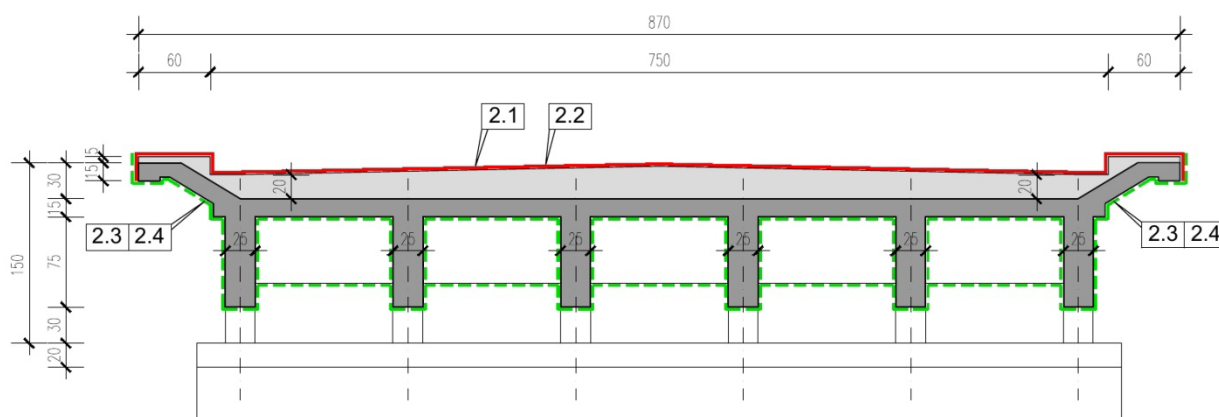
Sezione tipologica impalcato - fase di impermeabilizzazione
